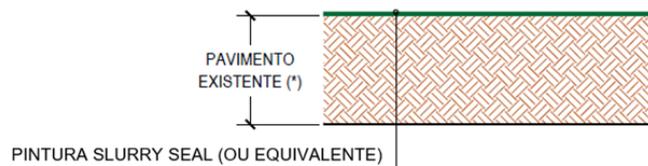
| Pavimentação – Faixa Ciclável definida em Slurry Seal, ou equivalente, sobre pavimento existente
